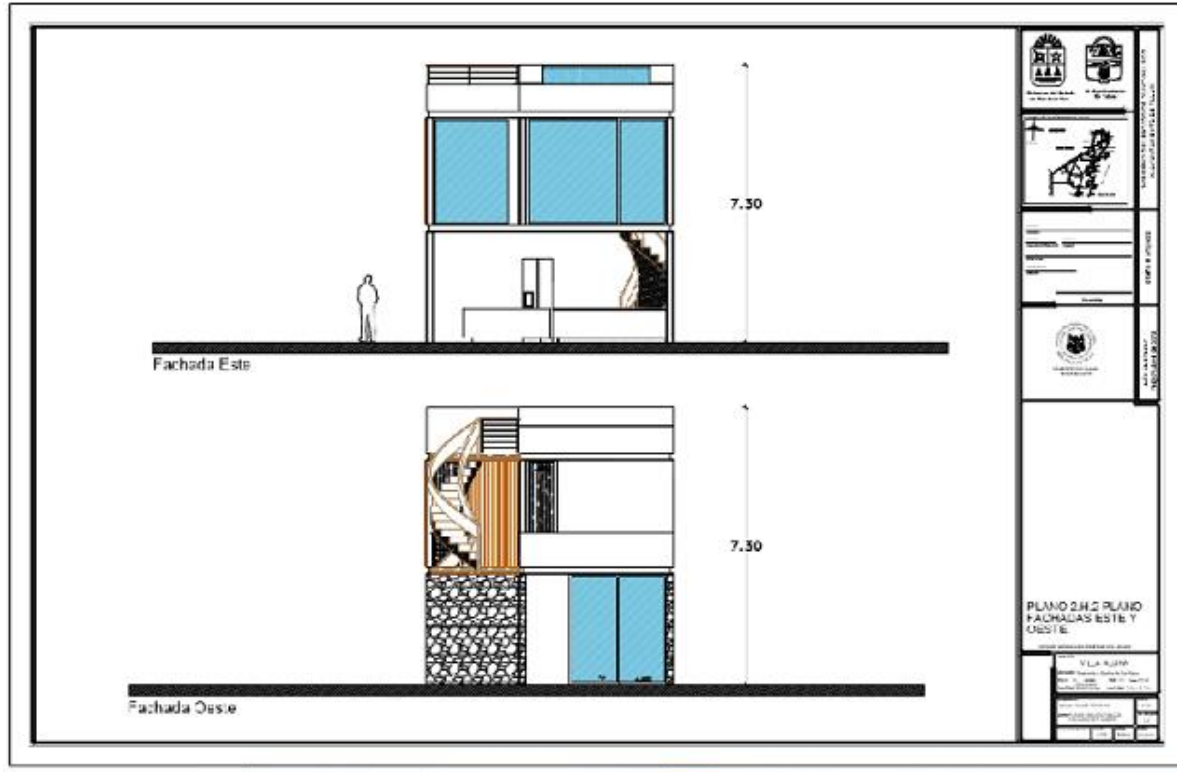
Fachada Este y oeste del proyecto "VILLA ALUNA"
